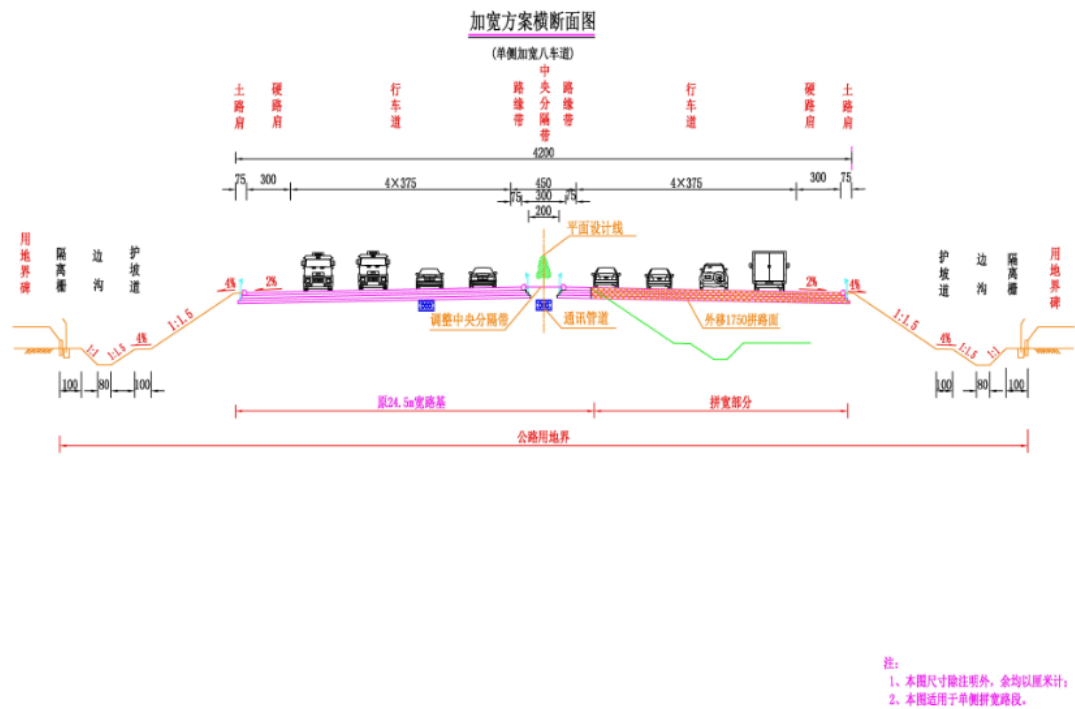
(3) 单侧加宽八车道路基标准横断面示意图
